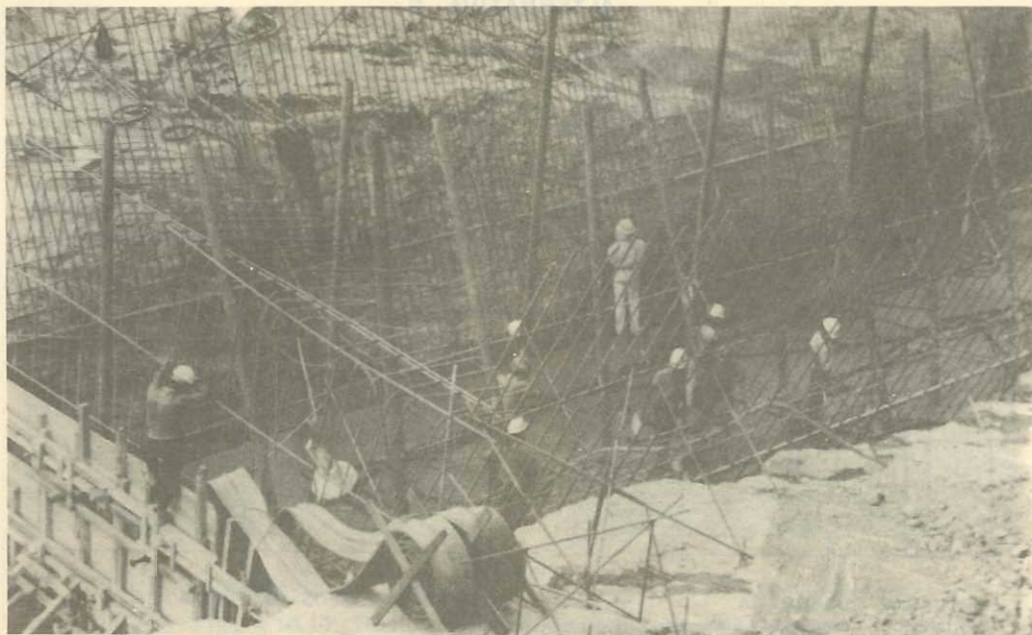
Observa-se veda-juntas instalados em uma camada sendo preparada para concretagem e o restante do material acondicionado em carretel protetor - Tucuruí
